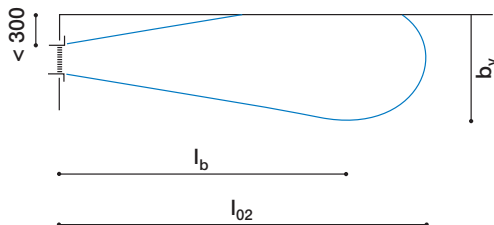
, Portée d'une grille installée à moins de 300 mm du plafond.
